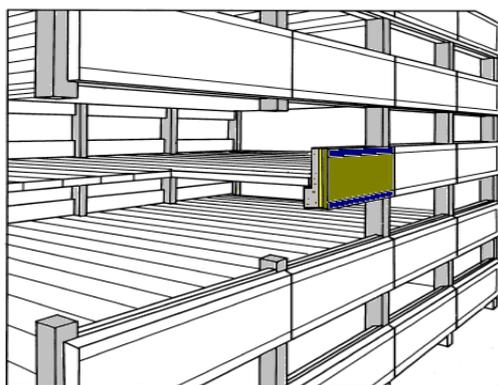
Elévation de façades en panneaux sandwichs : de type allèges portantes
